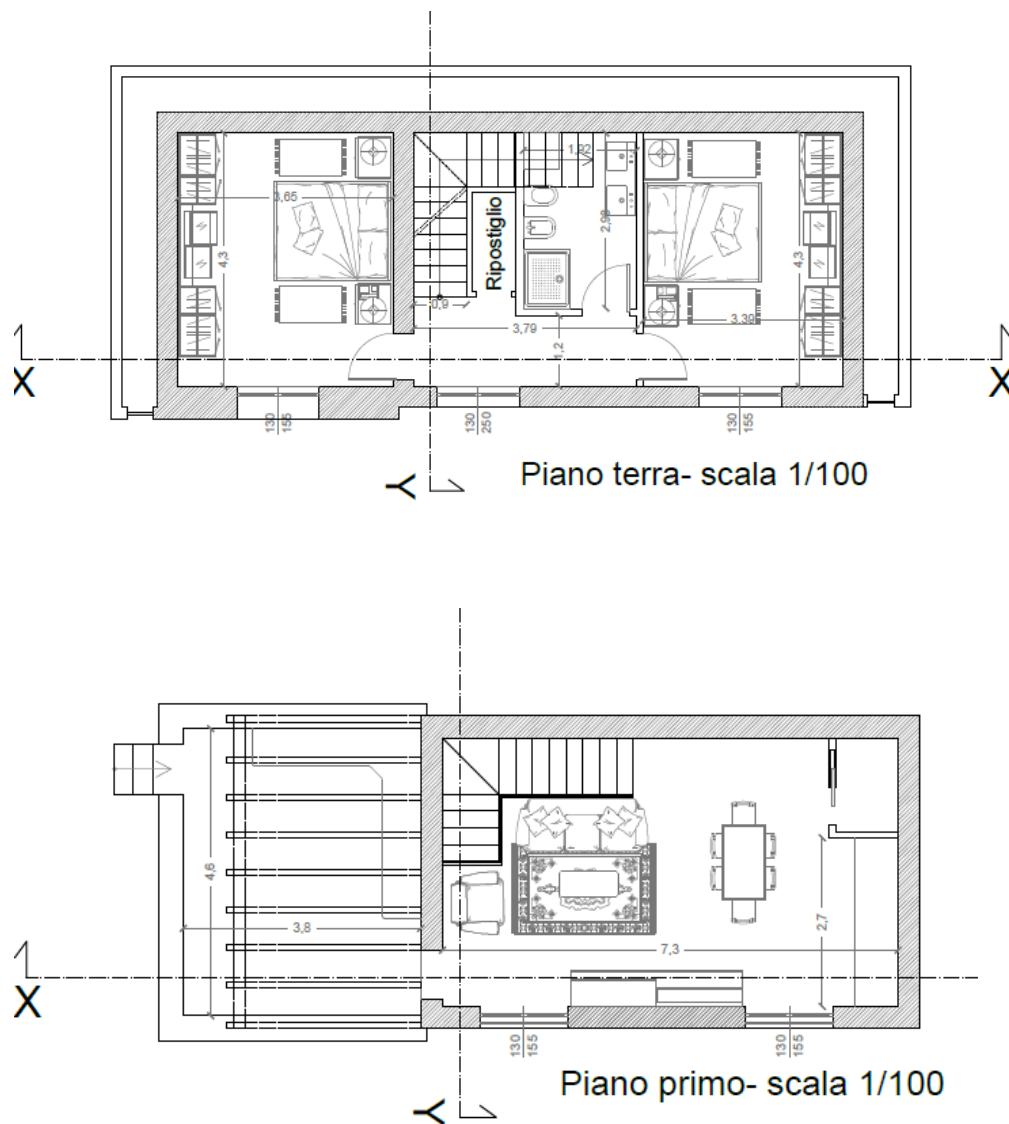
stralcio tavola 03 ProgeTec – planimetrie progetto
